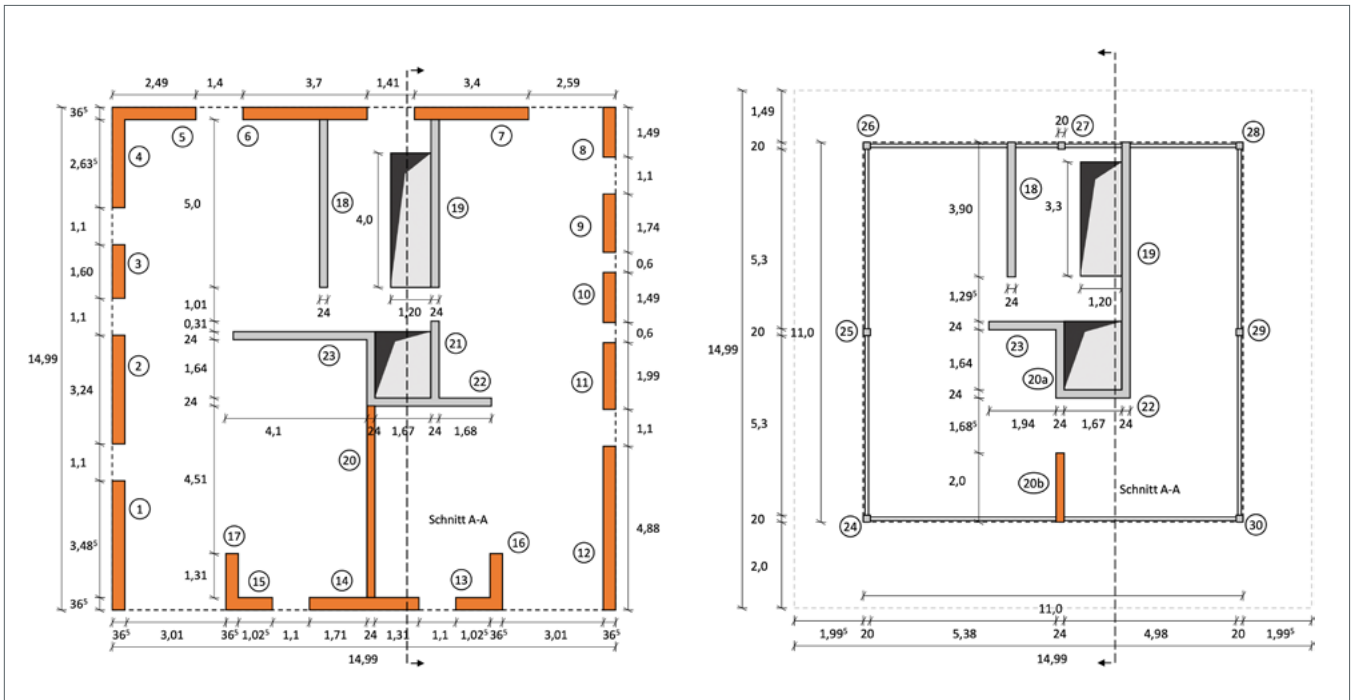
Grundrisse der Geschosse 1-3 (links) und des Staffelgeschosses (rechts) des Mehrfamilienhauses
